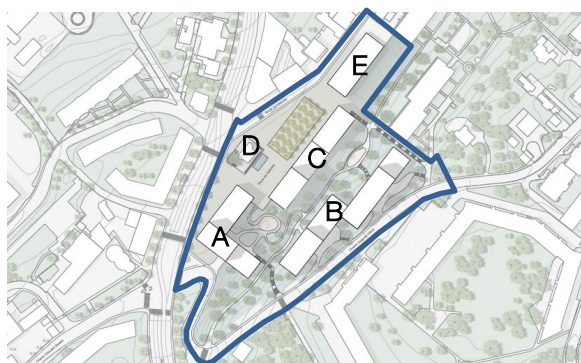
Plan masse du concours de 2016 (source : Group8) En bleu, le PLQ Carantec
